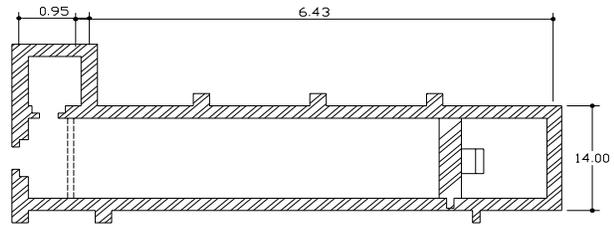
Fachada del templo de Zacán. Graf. 20 Planta del templo de San Pedro Zacán³⁶
